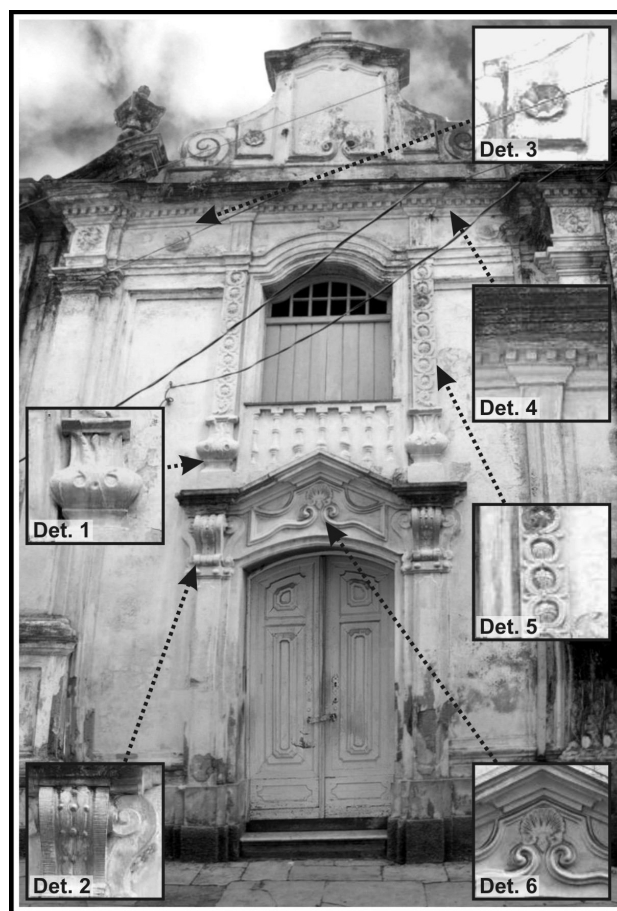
Fachada da Capela e detalhes dos ornamentos
